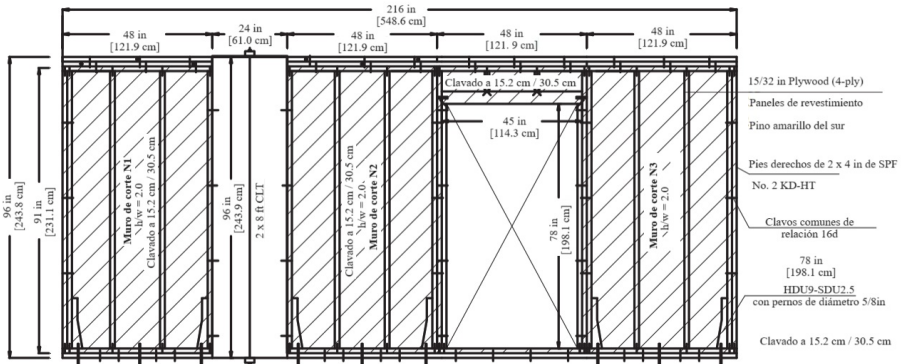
Sistema de muro híbrido CLT - Light frame, tomada de Nguyen et al. [34]
